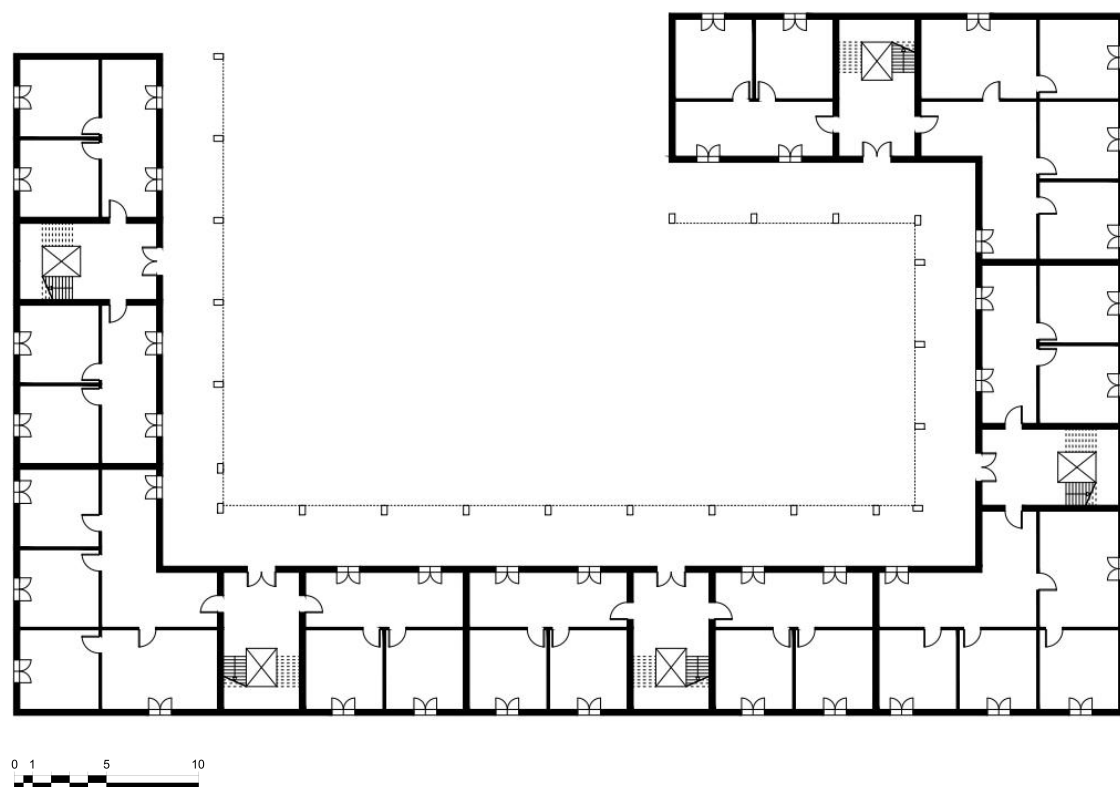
Pianta piano terra Edificio 1 - elaborazione dell'autore
